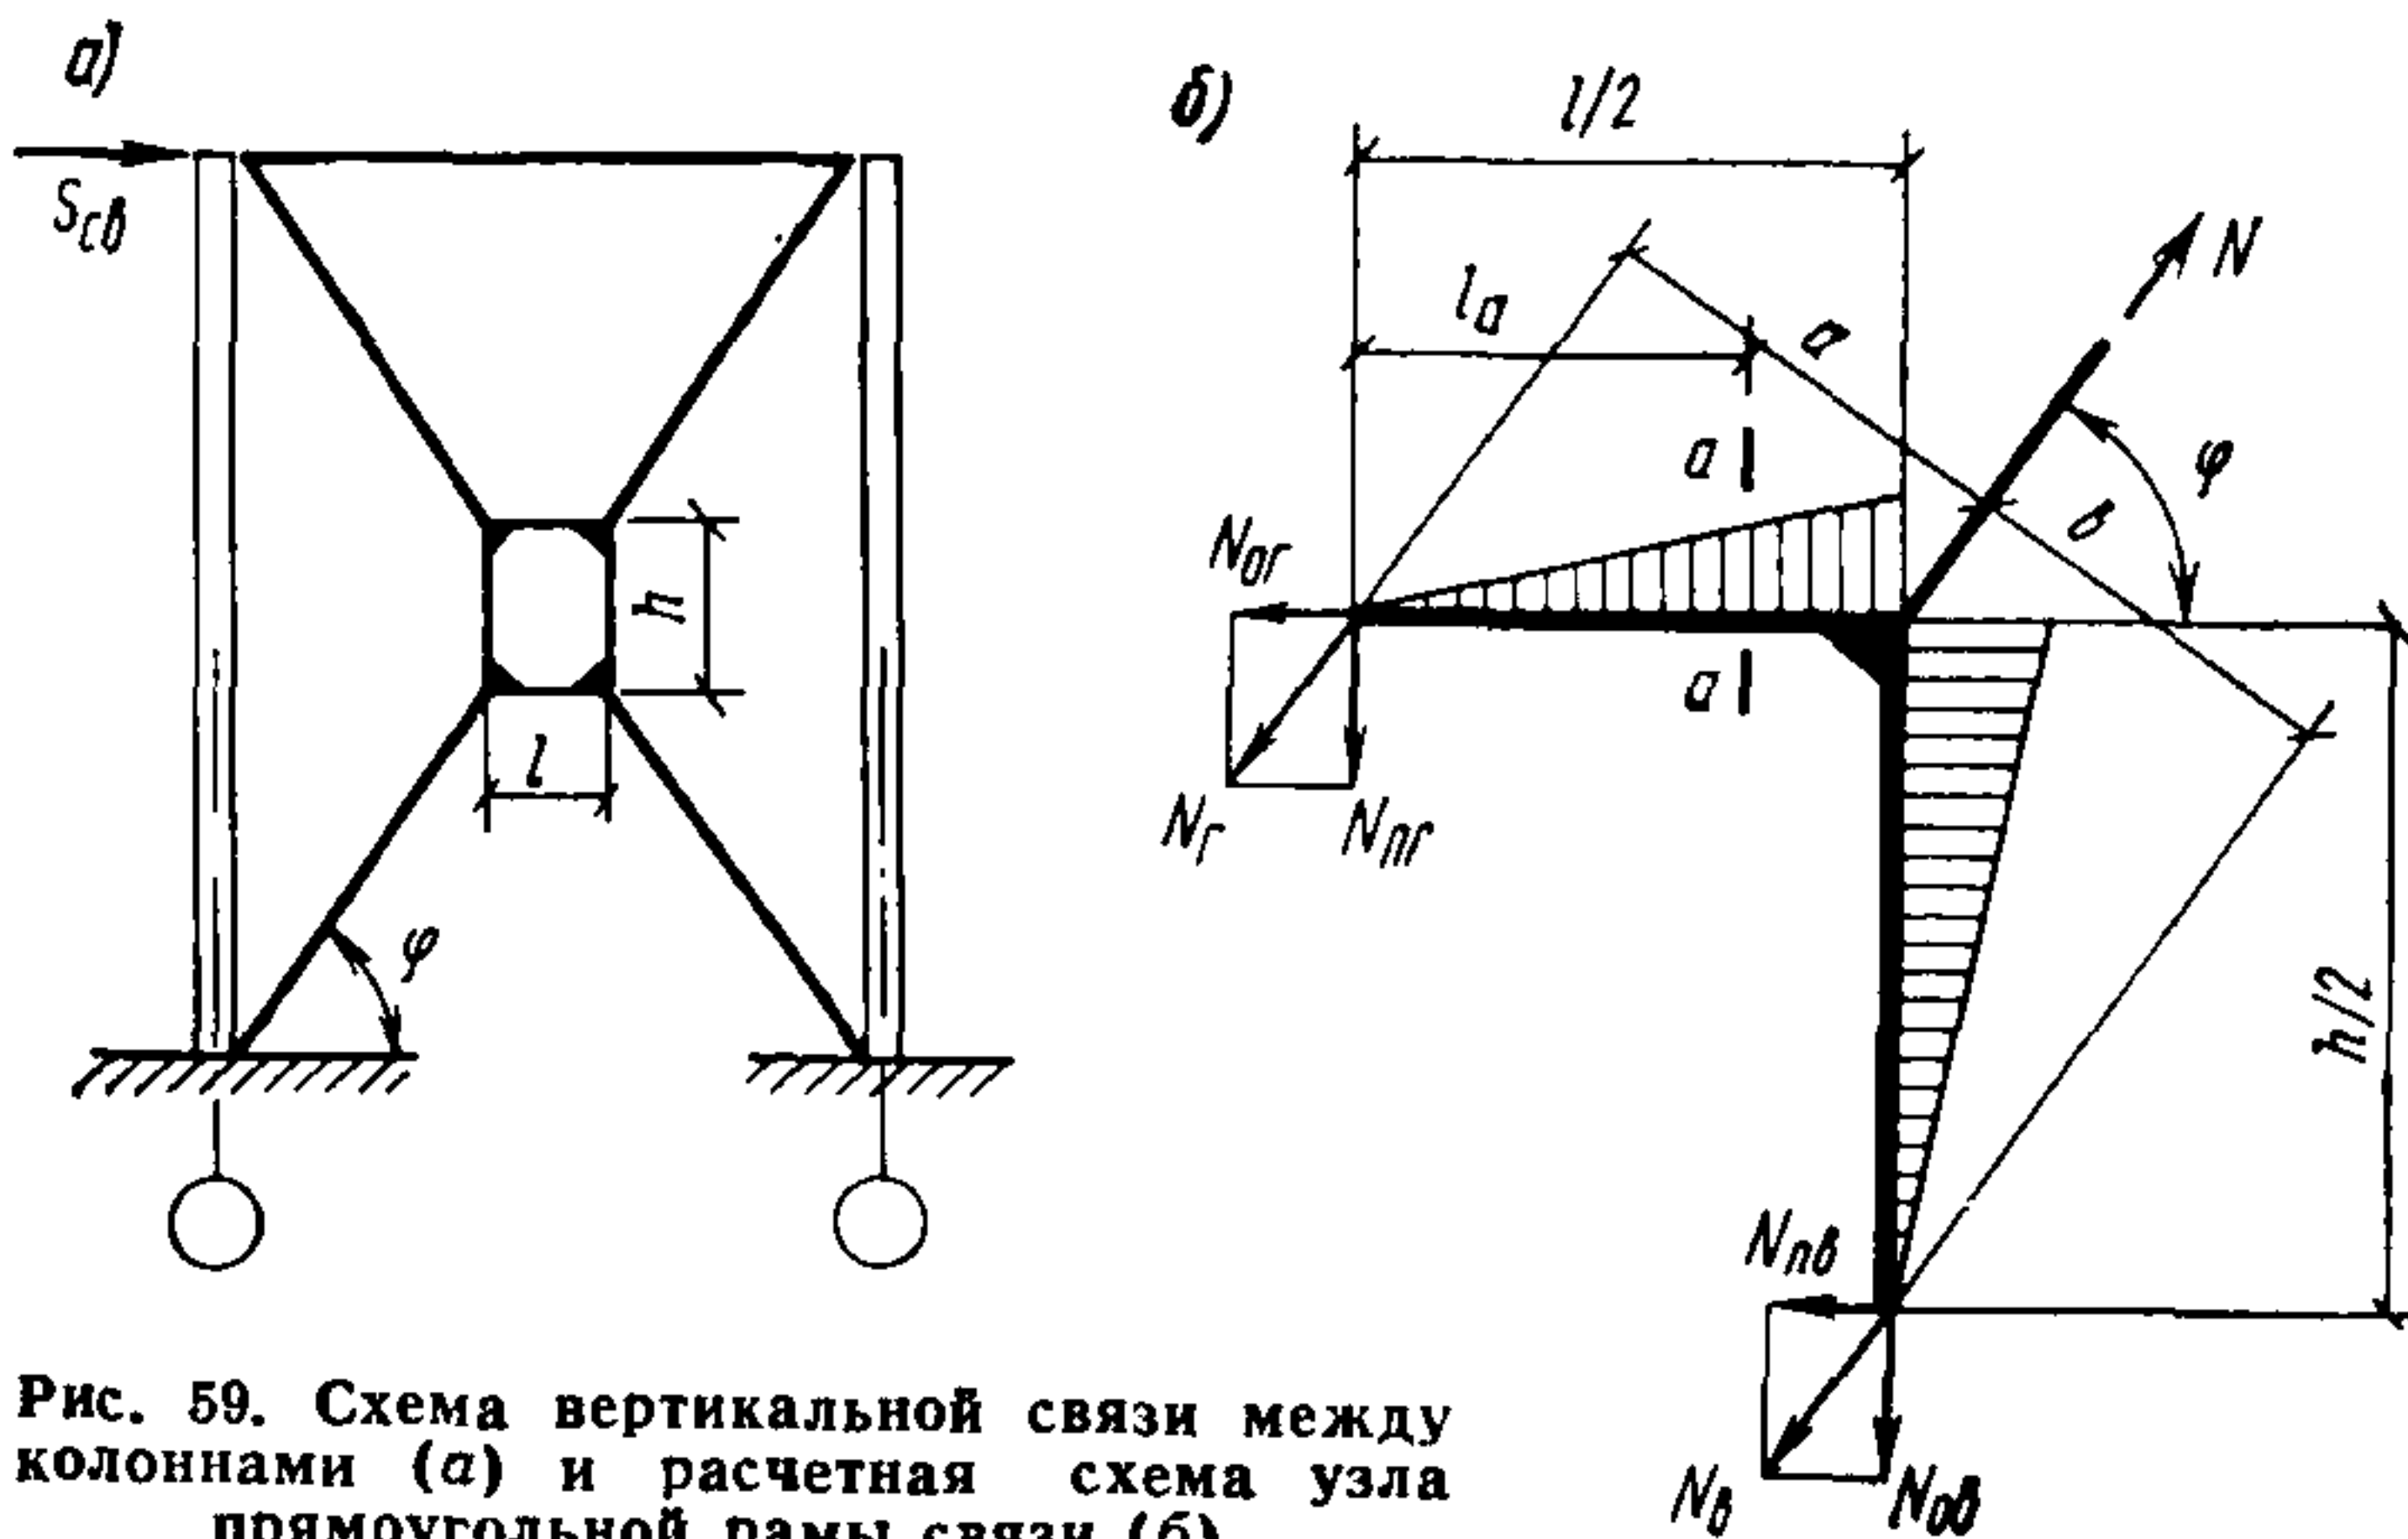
Схема вертикальной связи между колоннами (а) и расчетная схема узла прямоугольной рамы связи (б)
